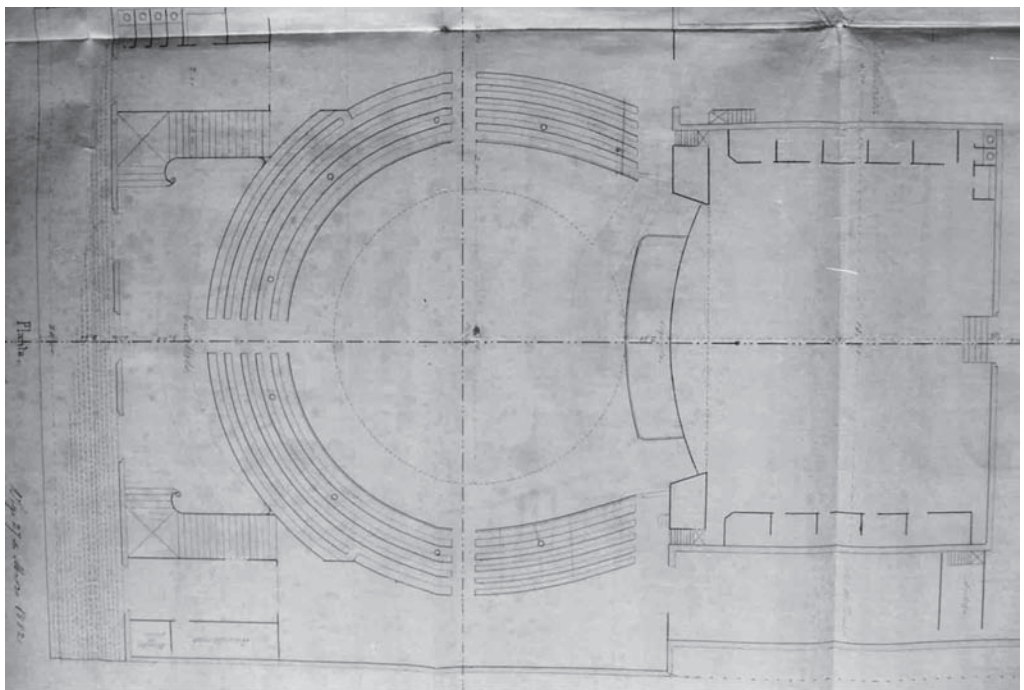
Proyecto del Teatro-Circo *Tamberlick*. D.R. Sesmero. 1882. Planta.
